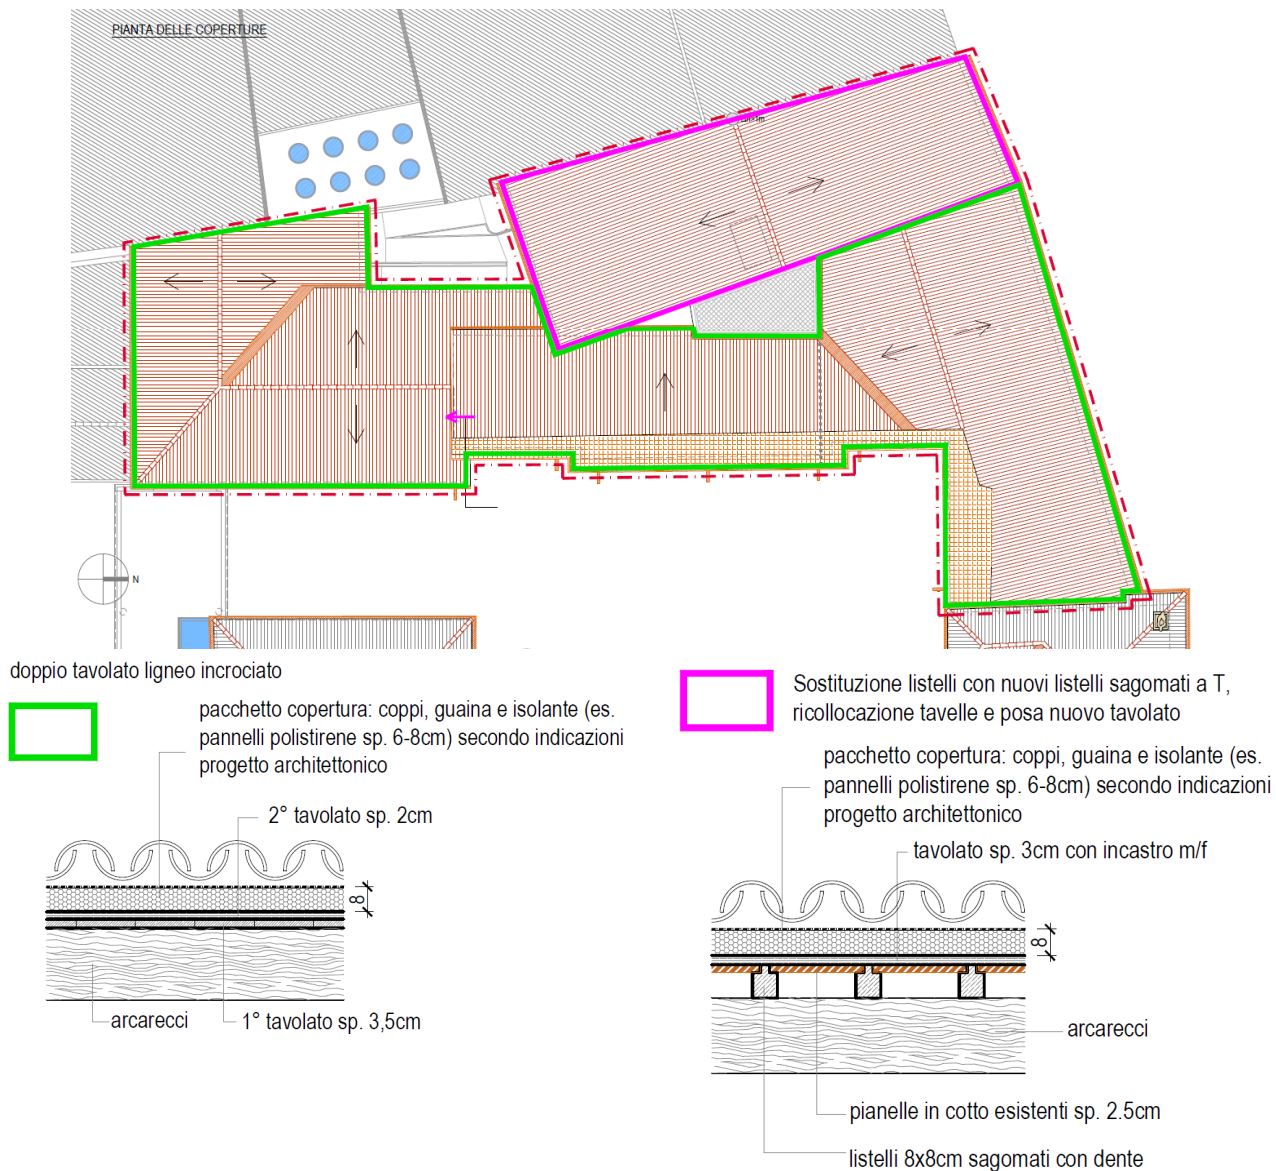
individuazione in pianta delle diverse tipologie di pacchetto copertura e relativi dettagli-tipo
